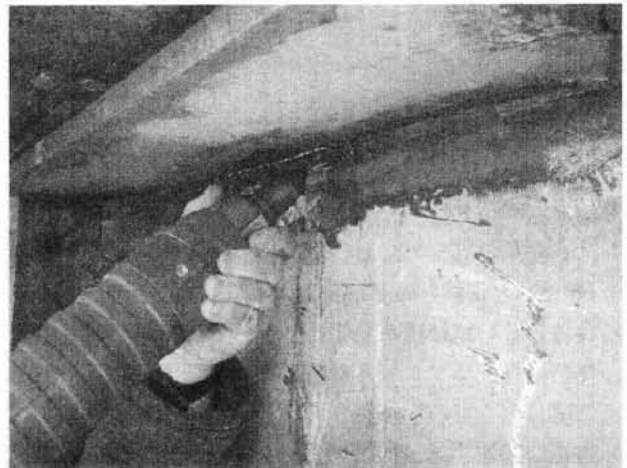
疲れき裂の補修溶接後のUP施工状況
